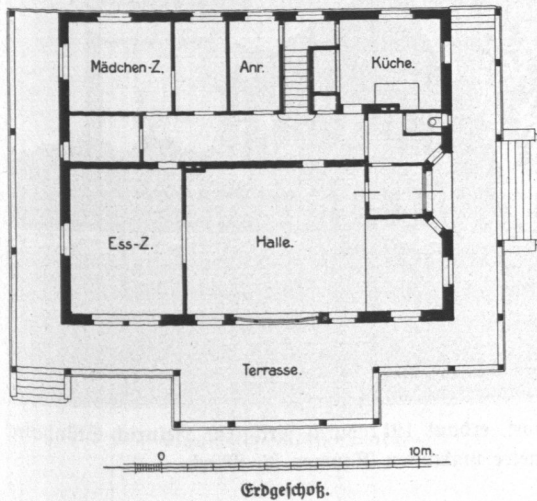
und 1130. Landhaus Westendarp, Wellingsbüttel, erbaut 1912 durch Architekt Johs. Voth. Baukosten 63500 Mark, für das Kubikmeter umbauten Raumes 32 Mark.
